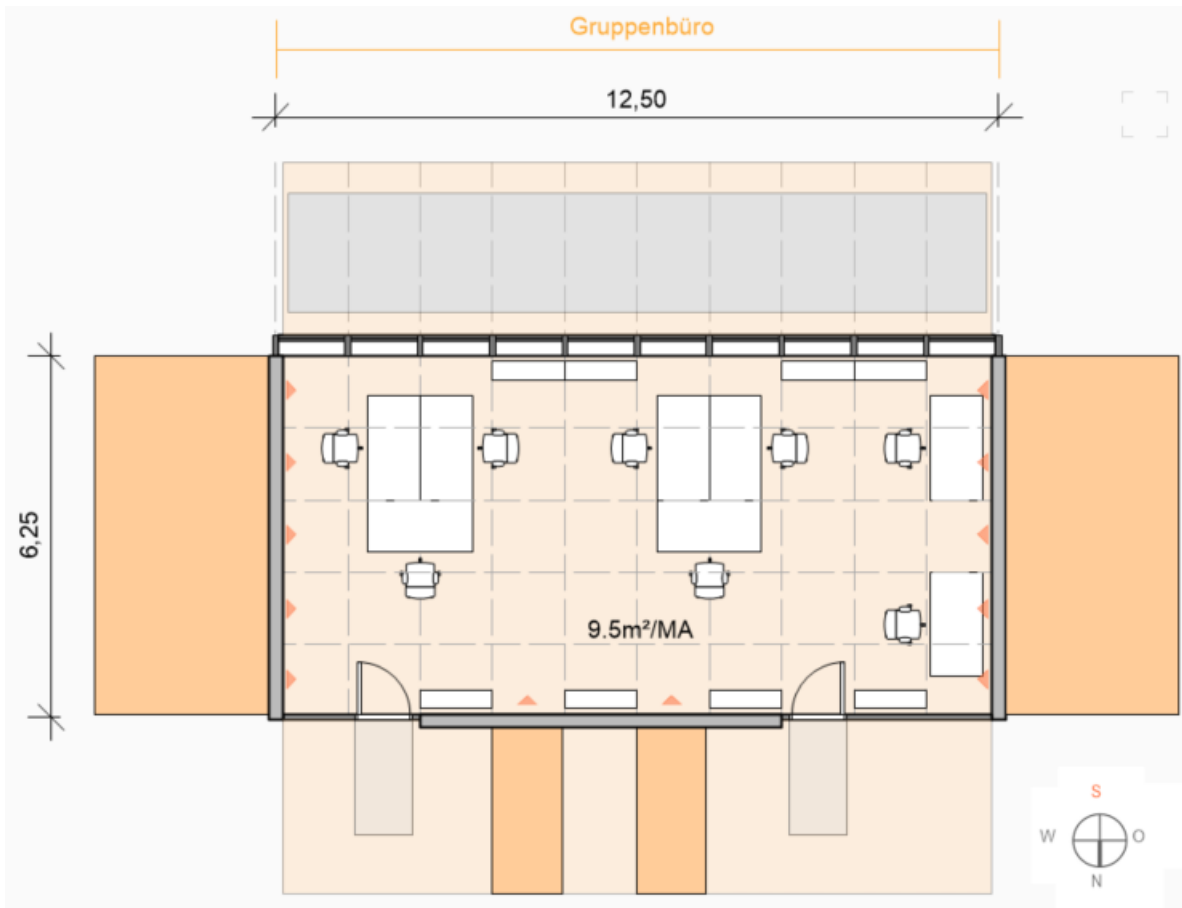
Gruppenbüro mit ca. 76 m² Grundfläche, vollverglaster Fassade mit außenliegendem Sonnenschutz, zwölf thermisch aktivierte Massivholzelemente
